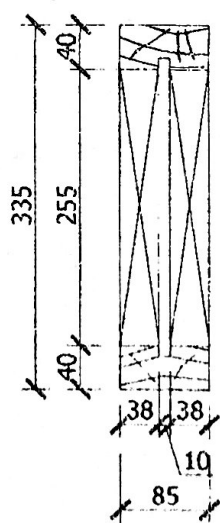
Соединение двутавровой балки на клеенных стержнях.
